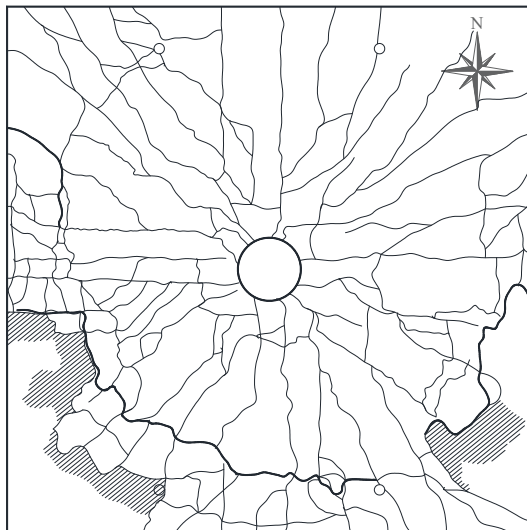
Mapa de fissuração da laje SS2
